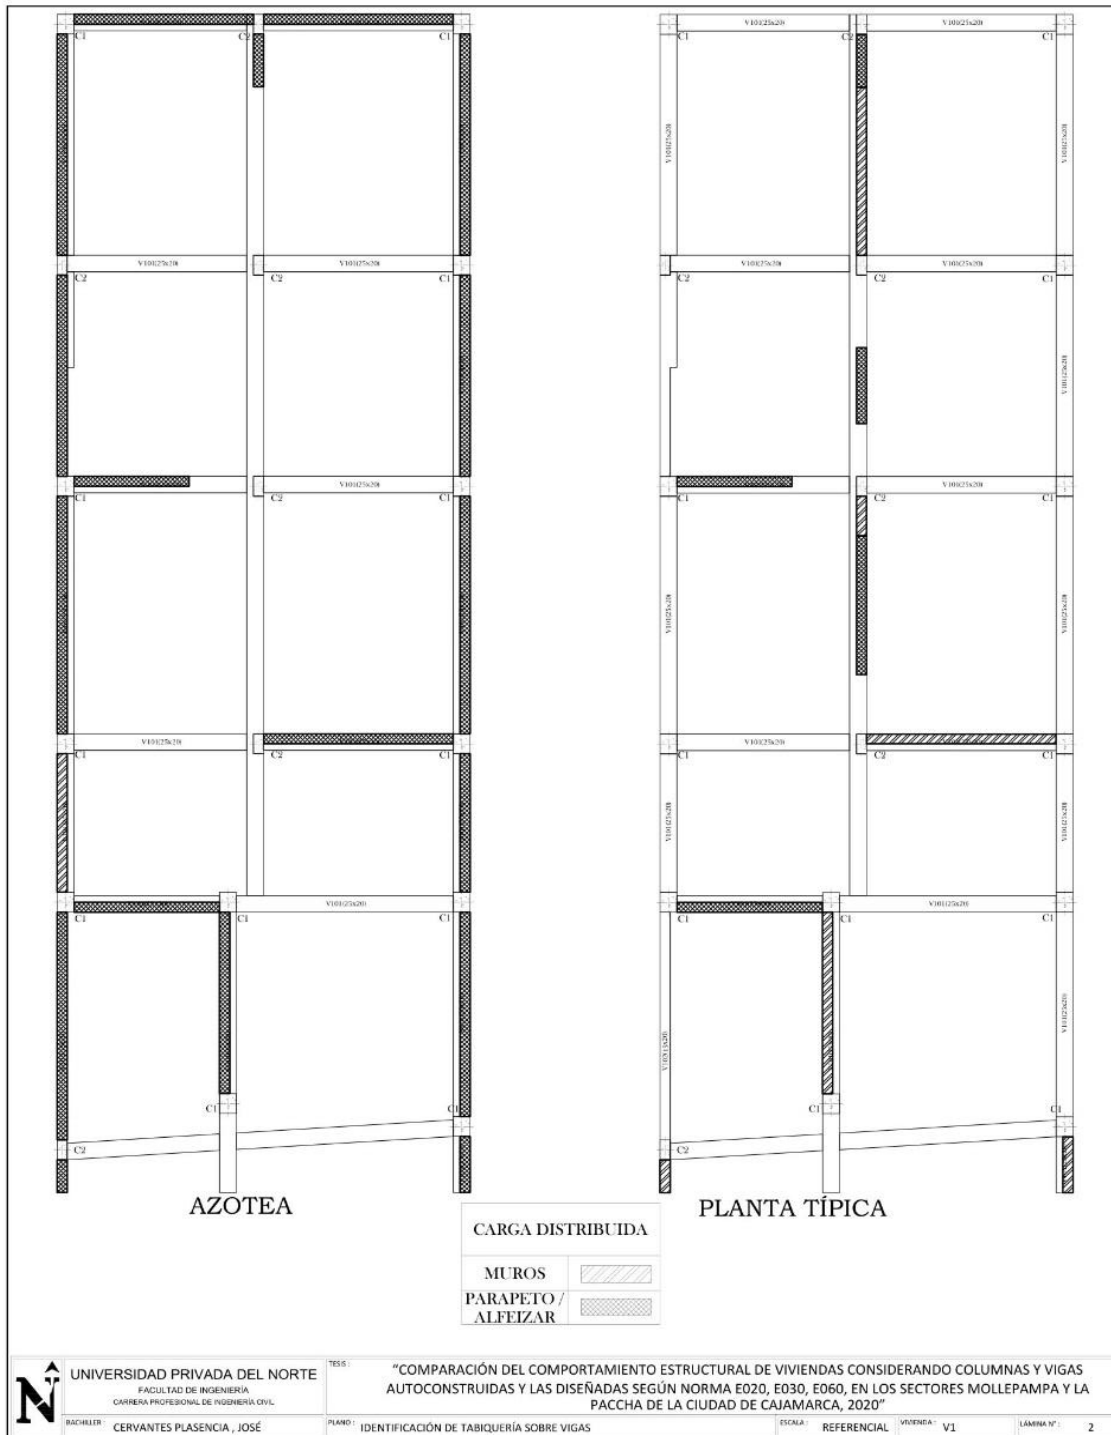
Identificación tabiquería sobre vigas vivienda 1.
